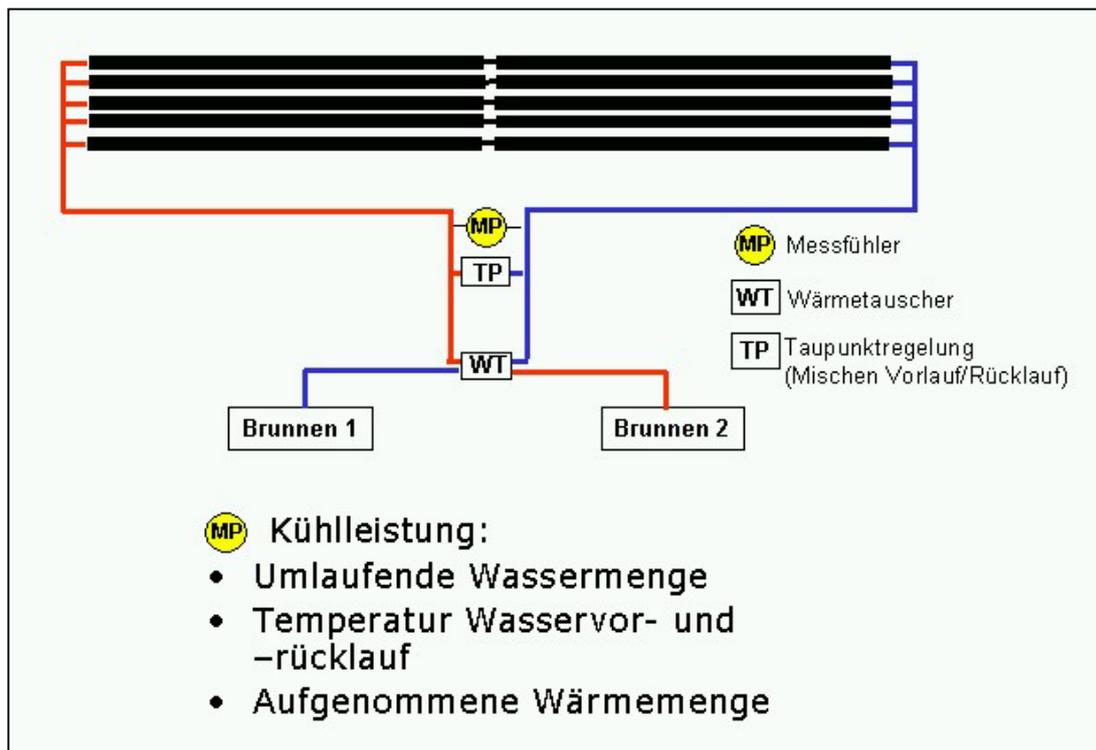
Schema der Kühldecke mit Steuerung, Wasserzufuhr und -ableitung
